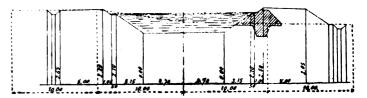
Canale dalla Marne alla Saone. - Sezione normale del canale.
